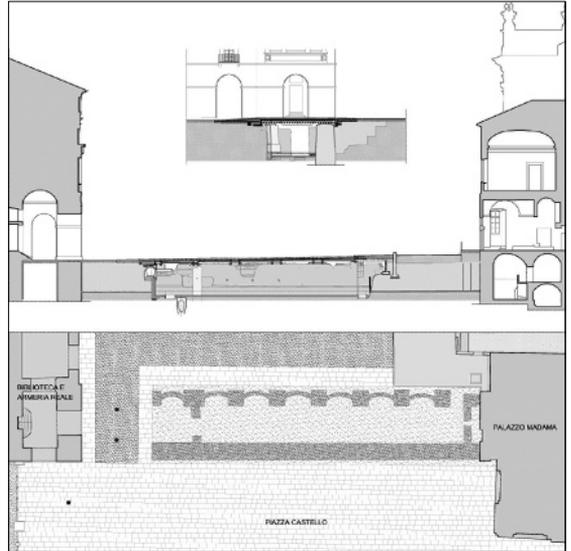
Piazza Castello, Torino, Galleria di Carlo Emanuele I. Progetto definitivo delle opere di restauro e riqualificazione delle aree esterne, FASE 1B. Planimetria e sezioni longitudinale e trasversale. Città di Torino, Servizio Edilizia per la Cultura, 2010.
